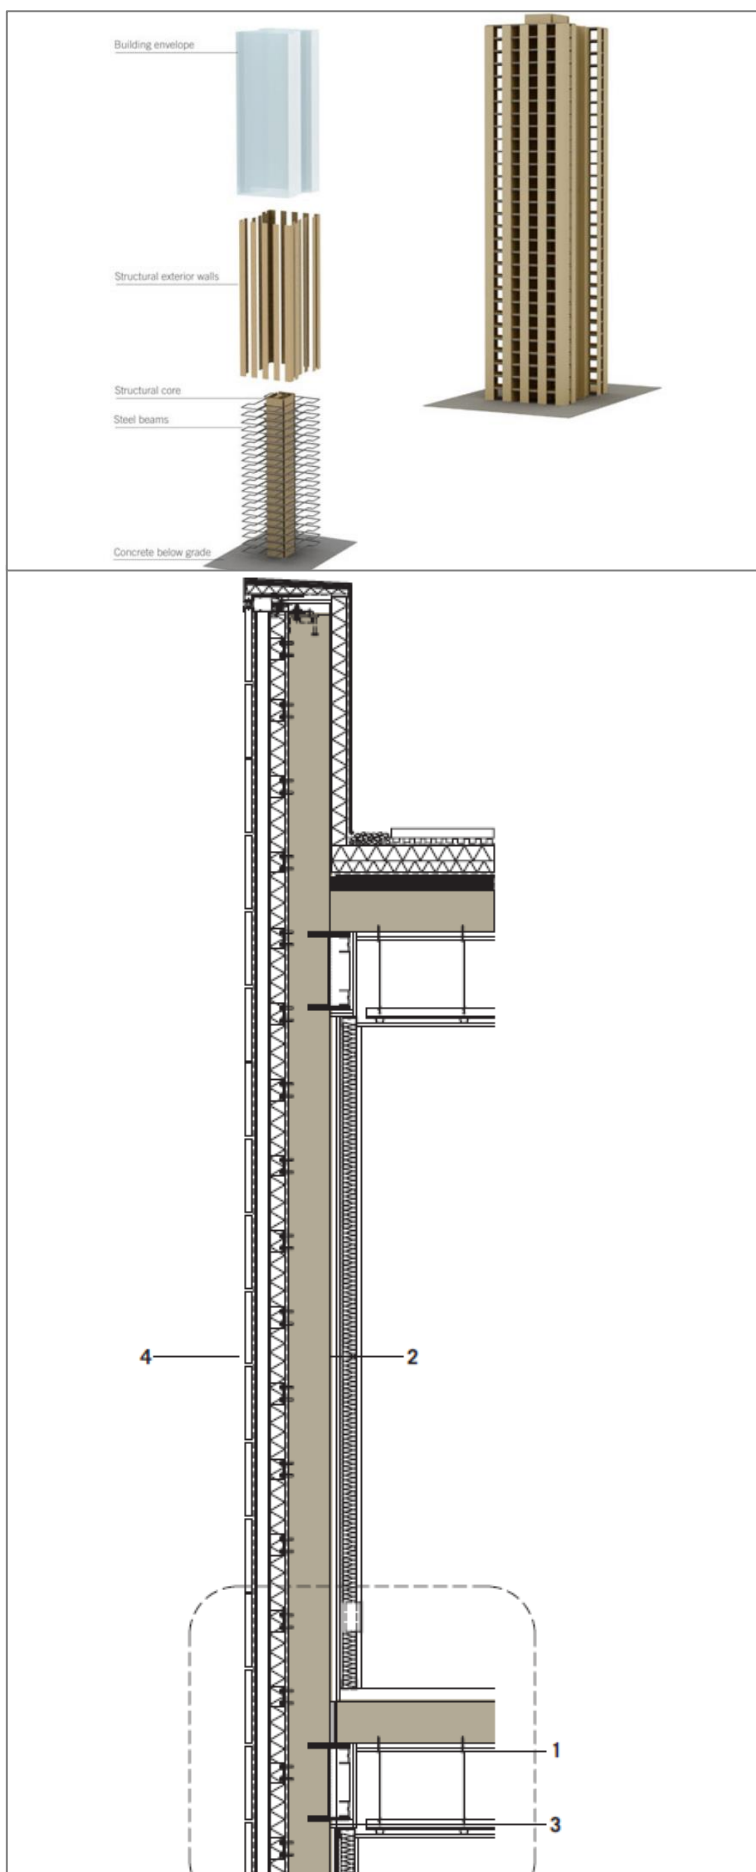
Esquema de construção da torre (1º. Fundações em betão; 2º. Caixa central de acessos verticais em madeira; 3º. Vigas metálicas; 4º. Paredes exteriores estruturais em madeira; 5º. Revestimento do edifício)
